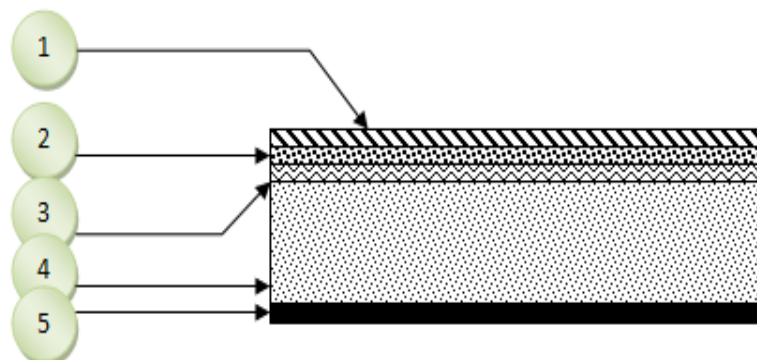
Schéma représente détail d'une dalle pleine.
